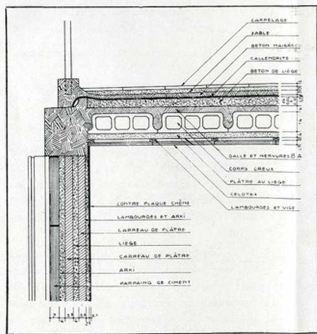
Coupe verticale d'un mur de façade et de la terrasse.
